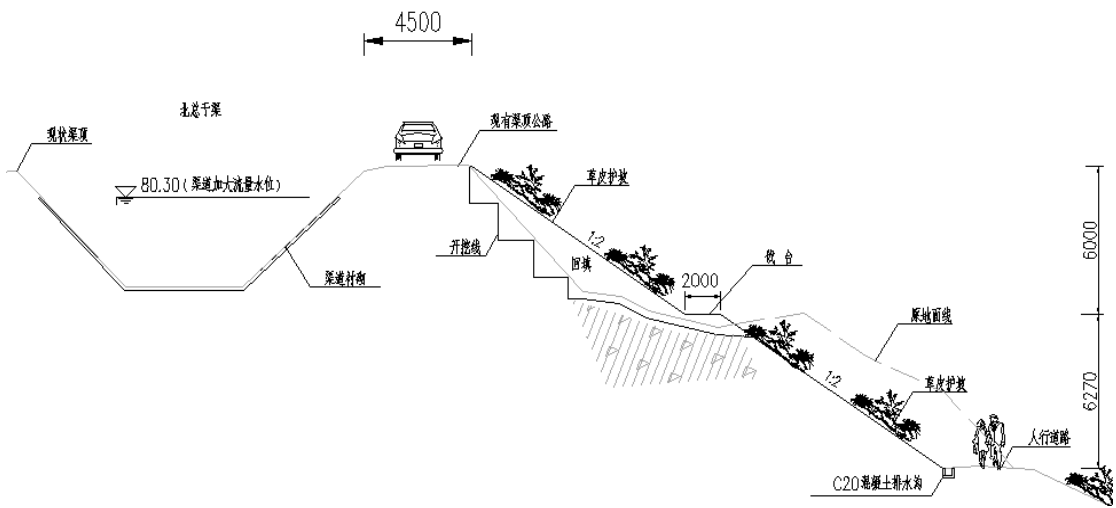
南总干渠 典型段渠堤垮塌治理断面图
